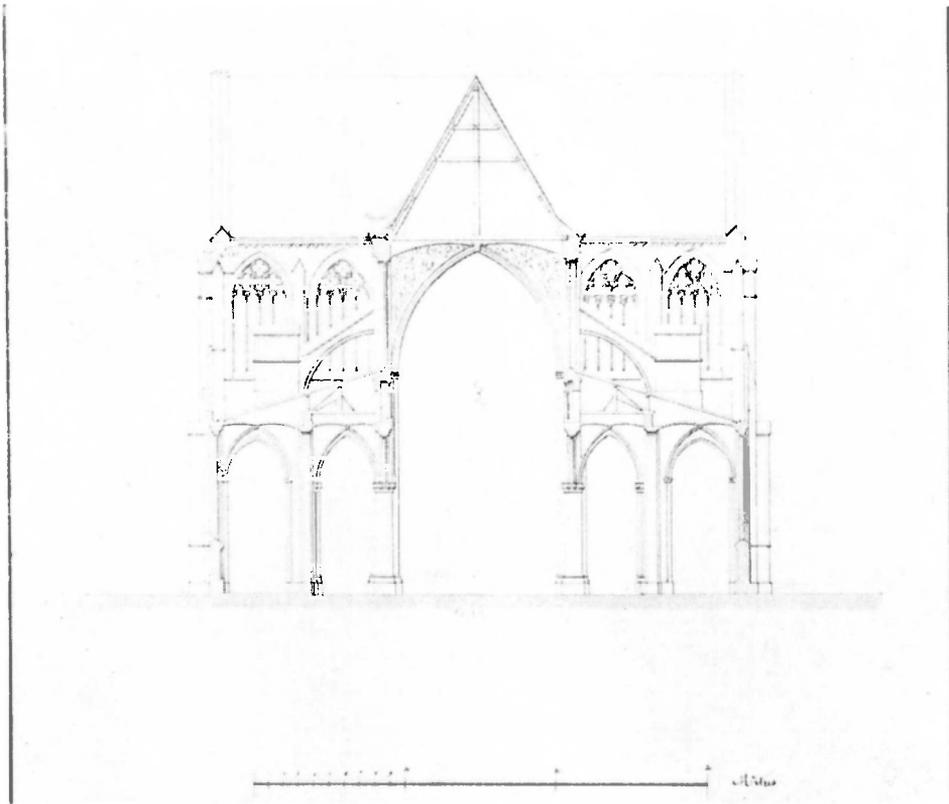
Coupe transversale sur la nef. Etat actuel en 1850.
